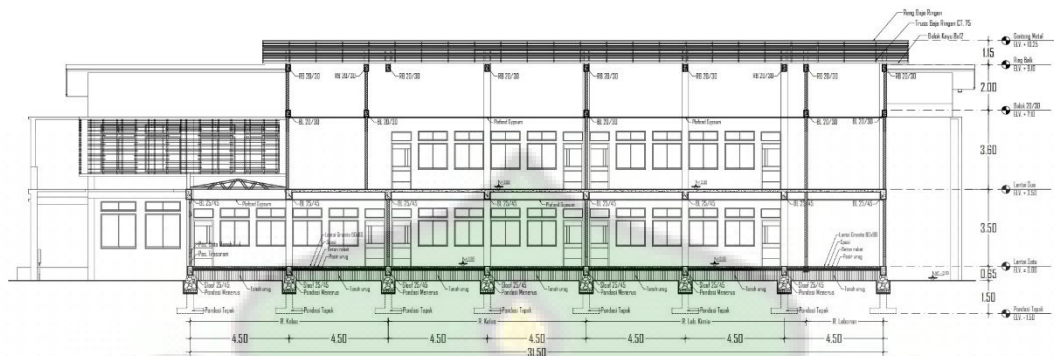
7 Tampak Depan dan Belakang Gedung Praktek
